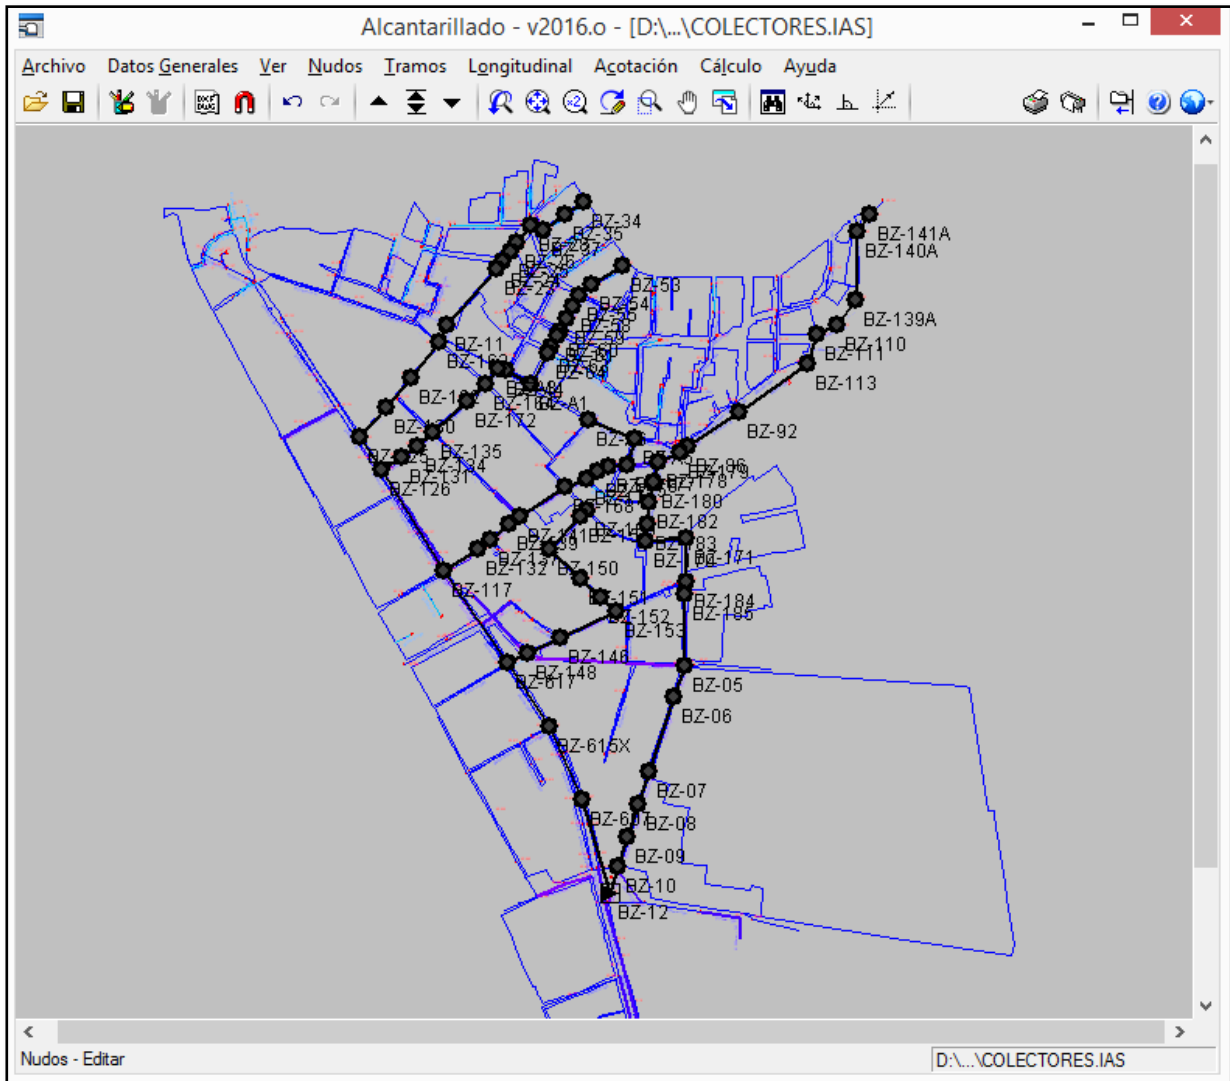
Procesado final de toda la red de alcantarillado - CYPE-Alcantarillado.
